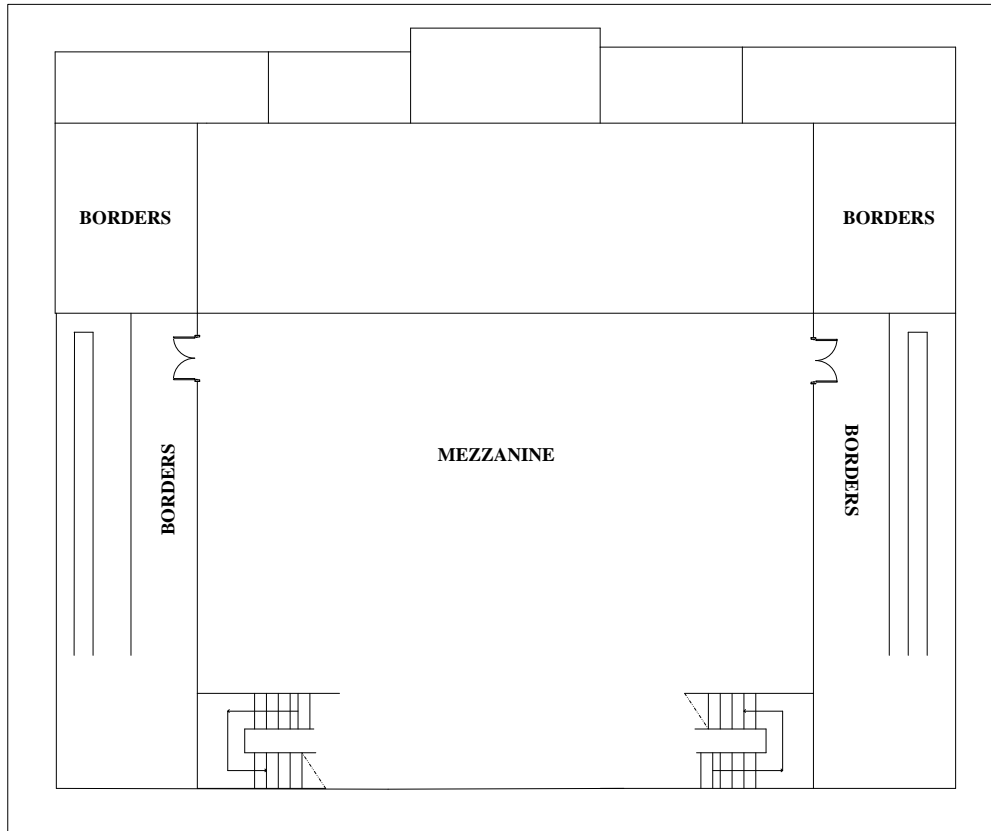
Layout Lantai 2 Gedung Student Center
